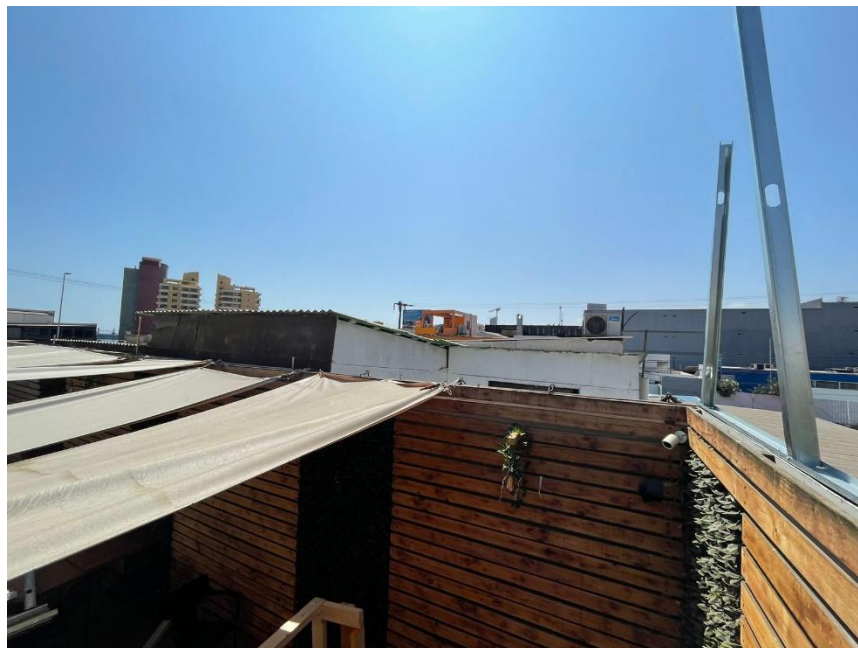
Instalación inicial metalcom levantamiento muralla sur
